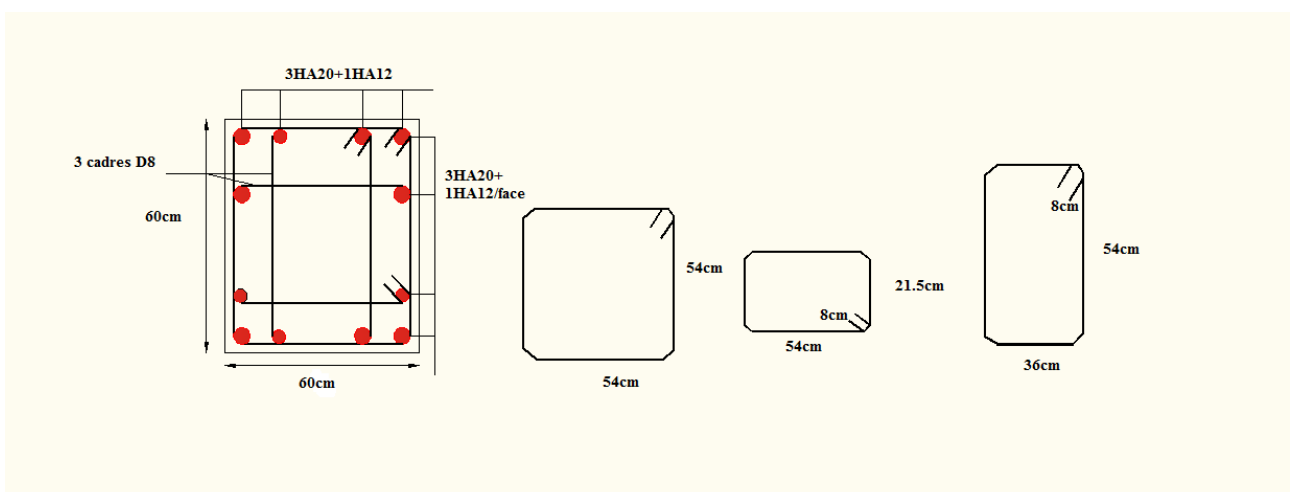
Schéma de ferrailage des poteaux d'étage 7
